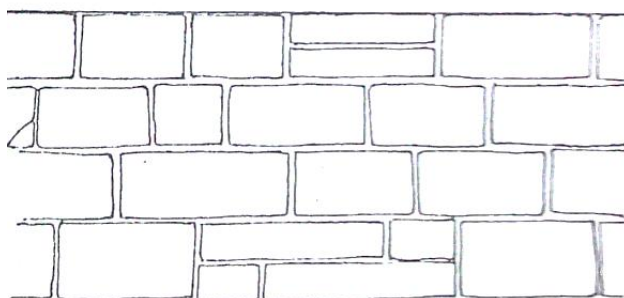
Mur en pierraille (Pietro Brenda, 1994)
